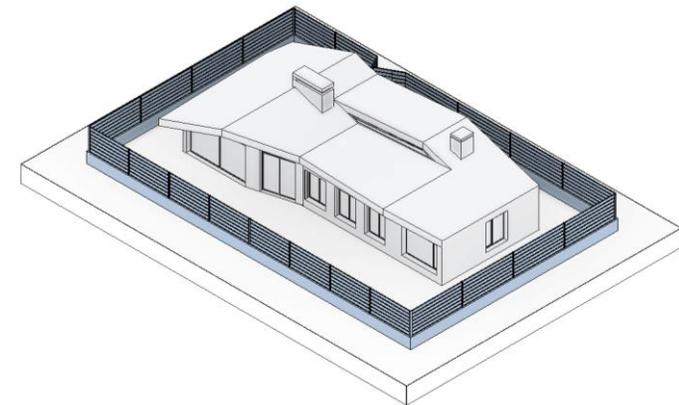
Modelo Revit, muro exterior. Fuente: Elaboración propia.
